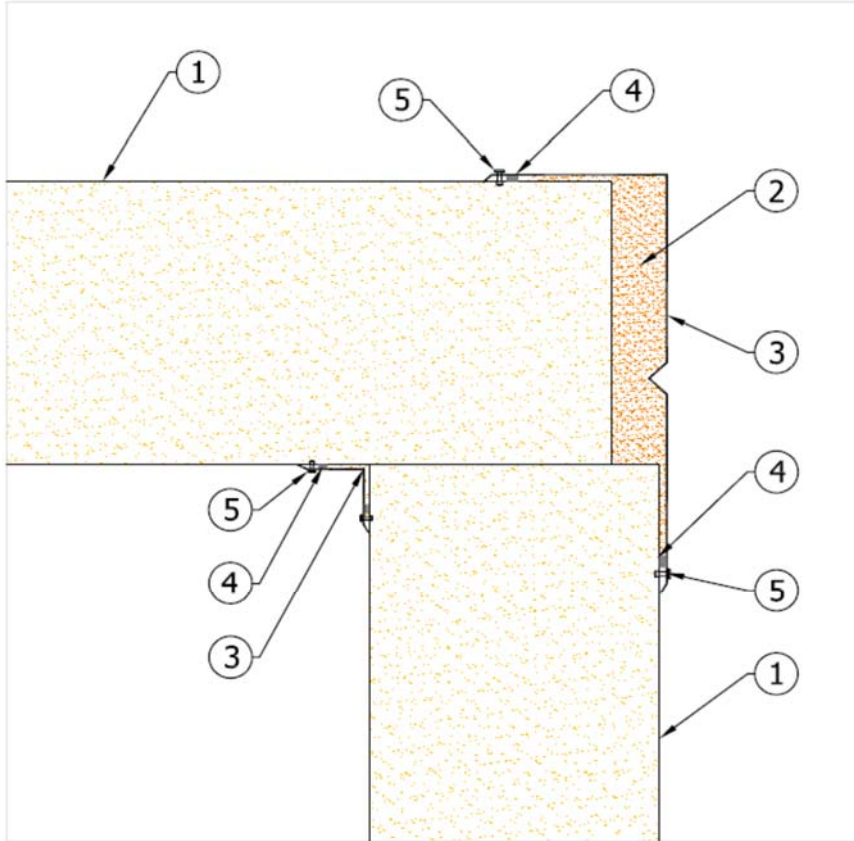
Raccordement paroi/paroi et paroi non porteuse/plafond (l'ossature et les fixations du plafond ne sont pas représentées)
